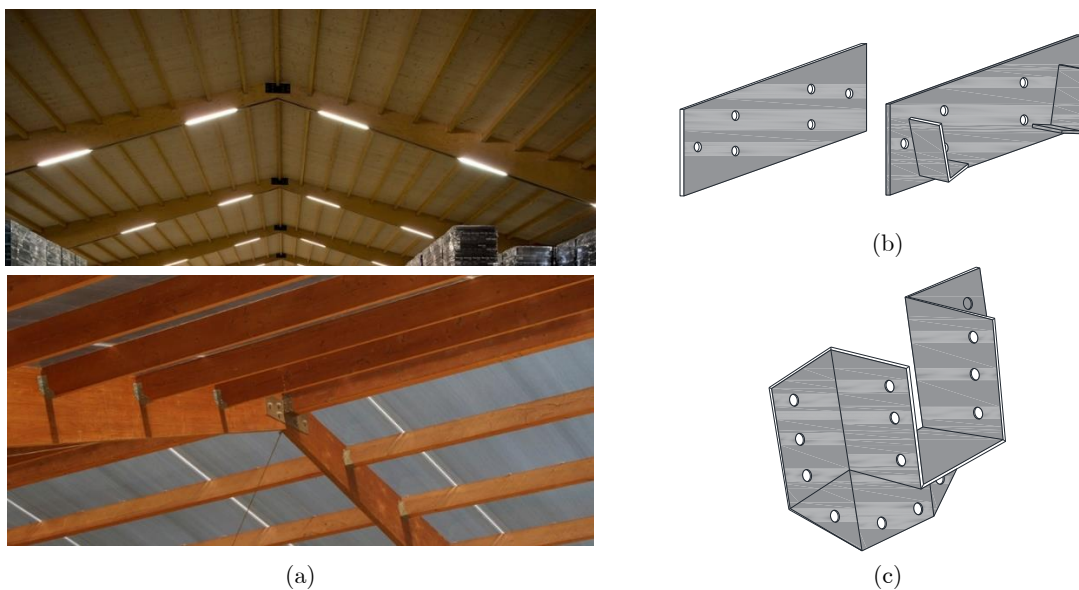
ligações viga com viga e com longarinas: a) Herdade de Esporão e Picadeiro Mafra [Adaptado (Jular, 2021)]; b) ferragem da ligação viga-viga; c) ferragem de ligação viga-longarina e viga com viga.
